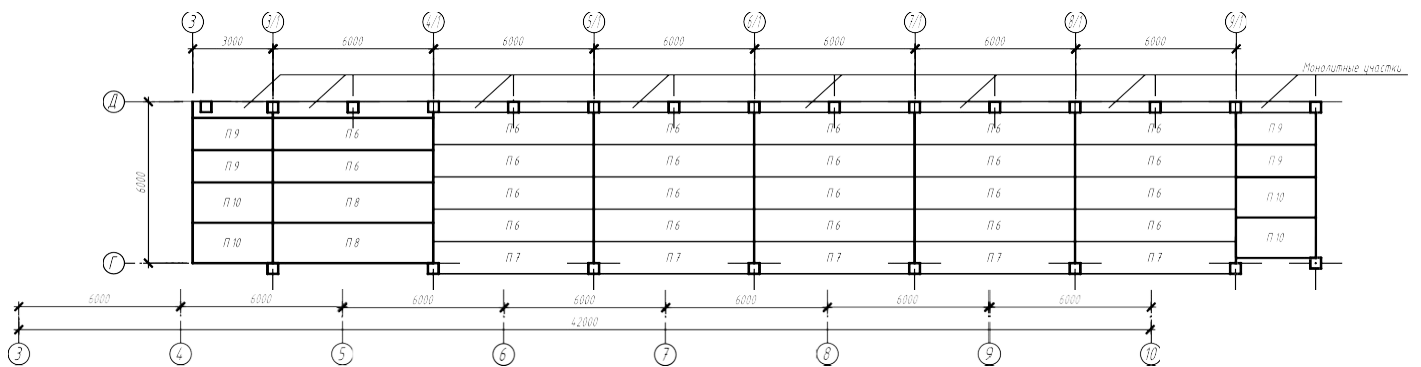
Схема розташування плит перекриття на відм. +4,800
